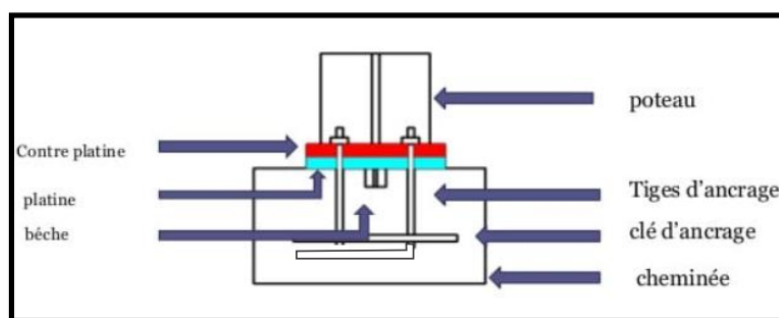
Figure SEQ Figure * ARABIC 91 : détail d'accrochage de poteau métallique et semelle en béton
